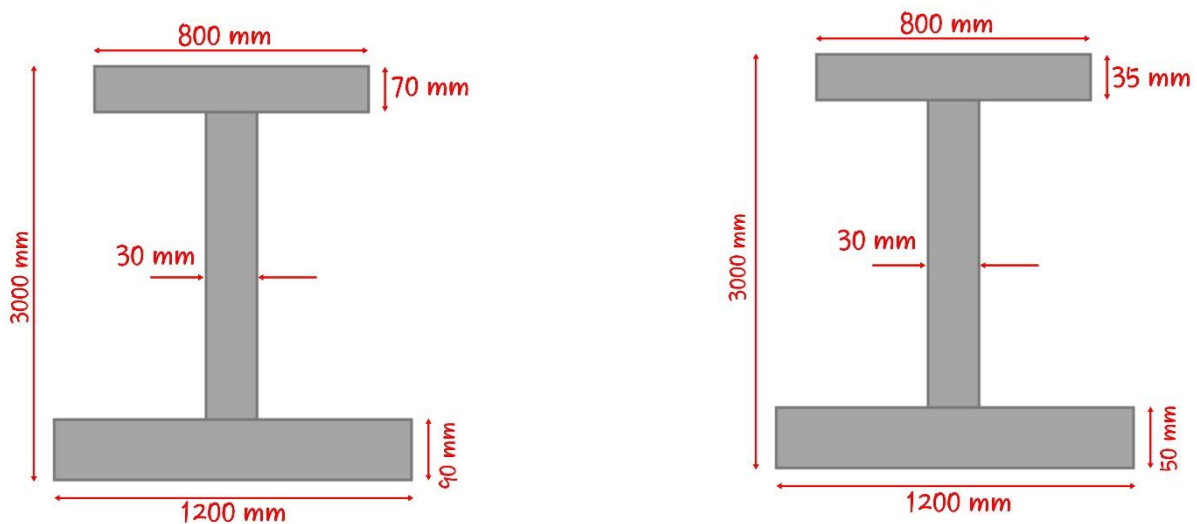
PRS à gauche (section sur appuis), à droite (section à mi-travée)
